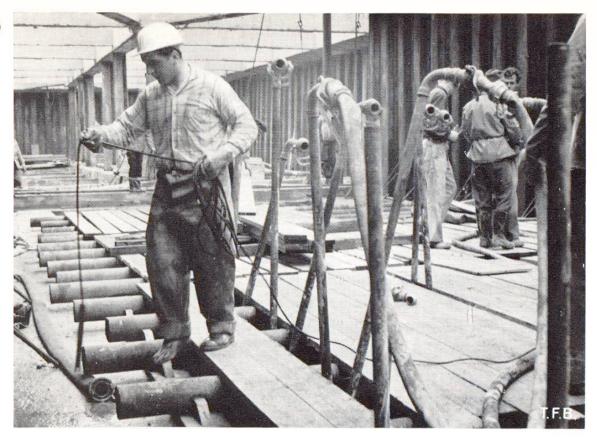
Mise en œuvre de béton Colcrete sous l'eau pour la construction d'un radier d'écluse.
